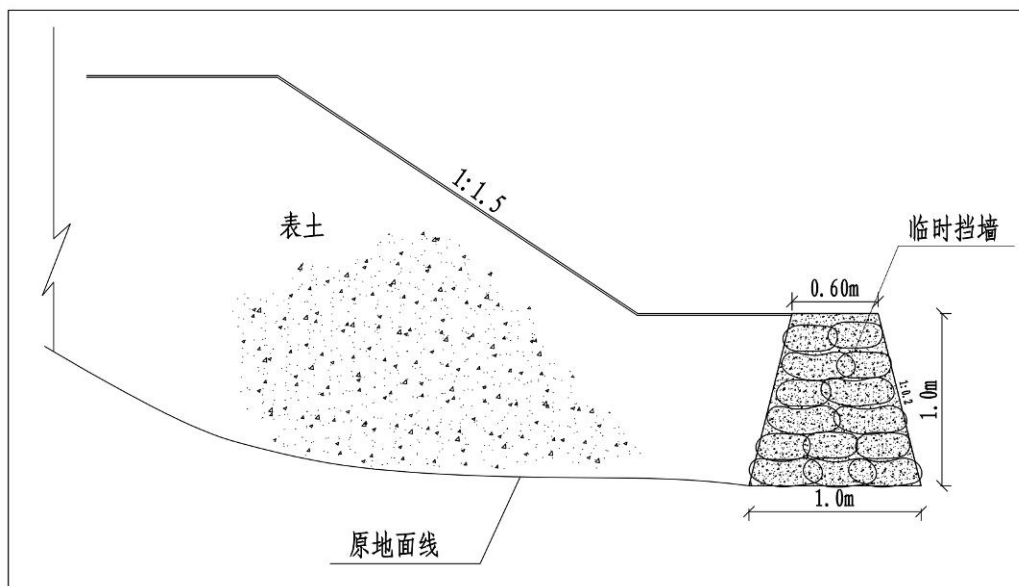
表土堆放及编织袋挡土墙施工断面图
